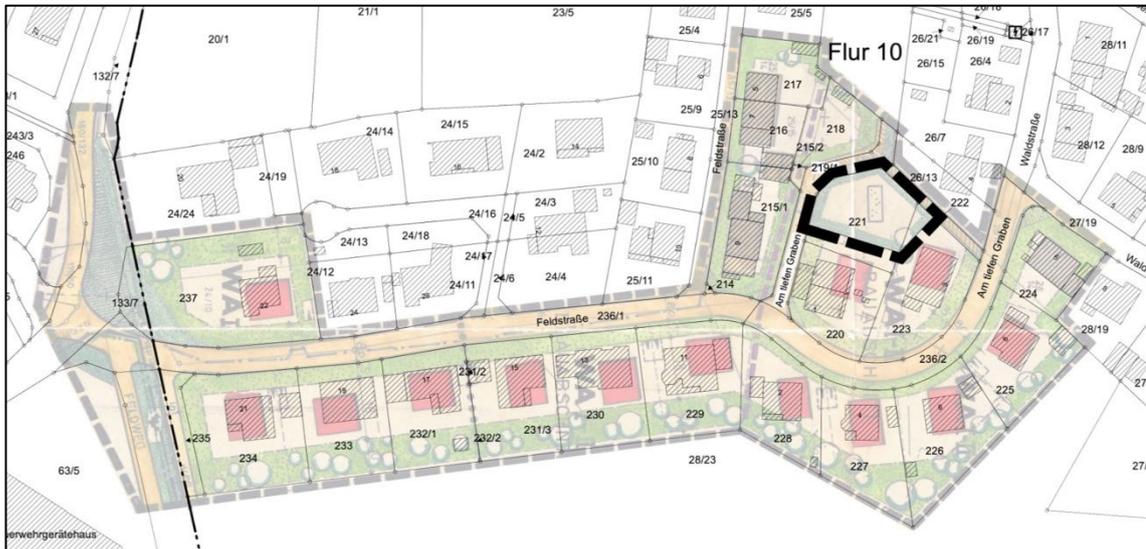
Teil-Bebauungsplan Nr. 3 - Planteil
